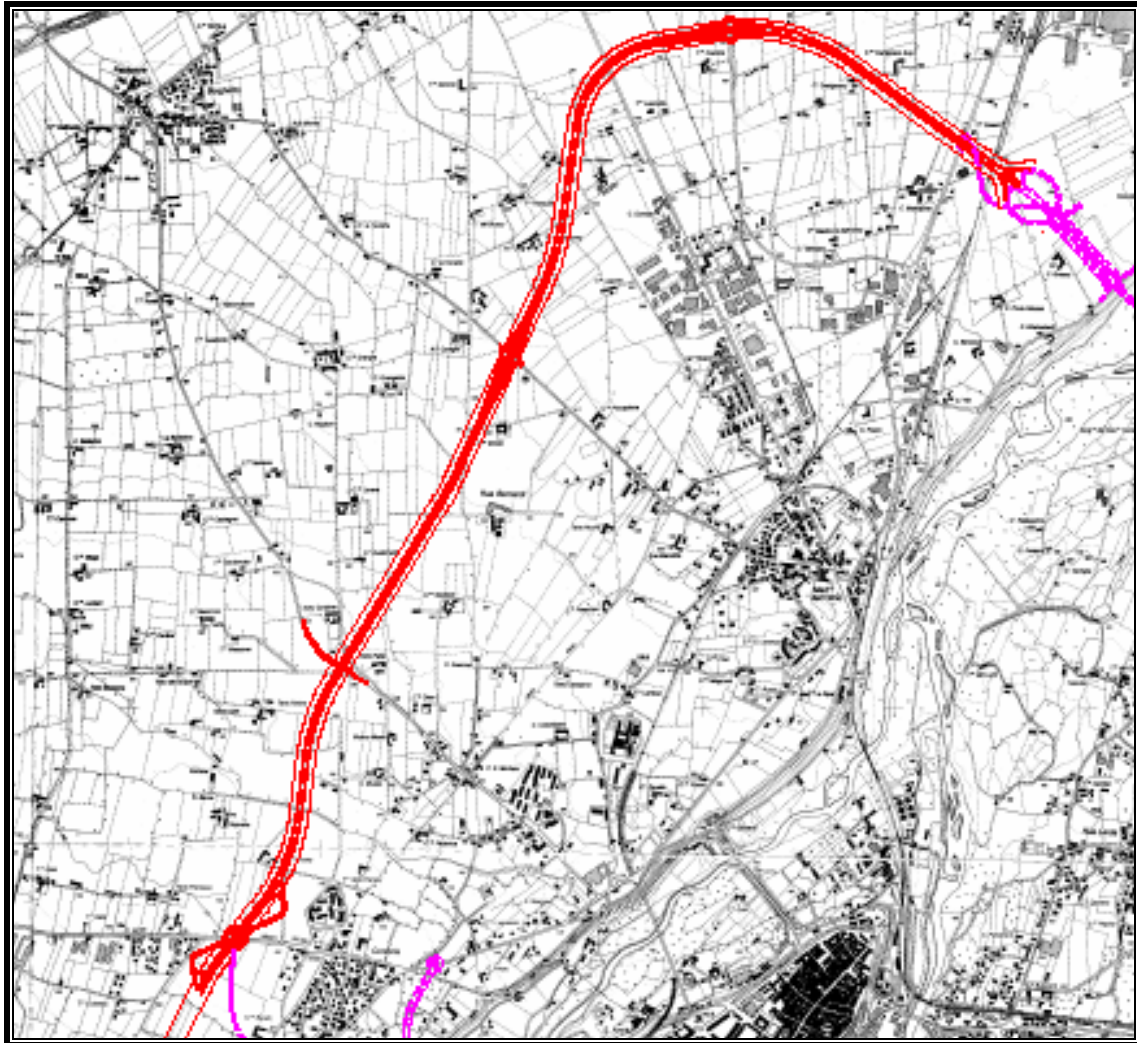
Planimetria con indicazione del tracciato in progetto.
